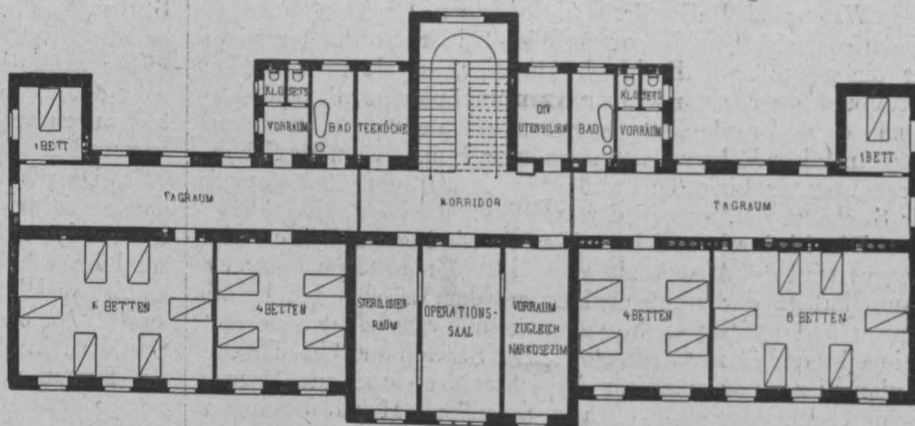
Hauptgebäude, Erster Stock; Kaiser Franz Josef-Bezirkskrankenhaus in Mistelbach
